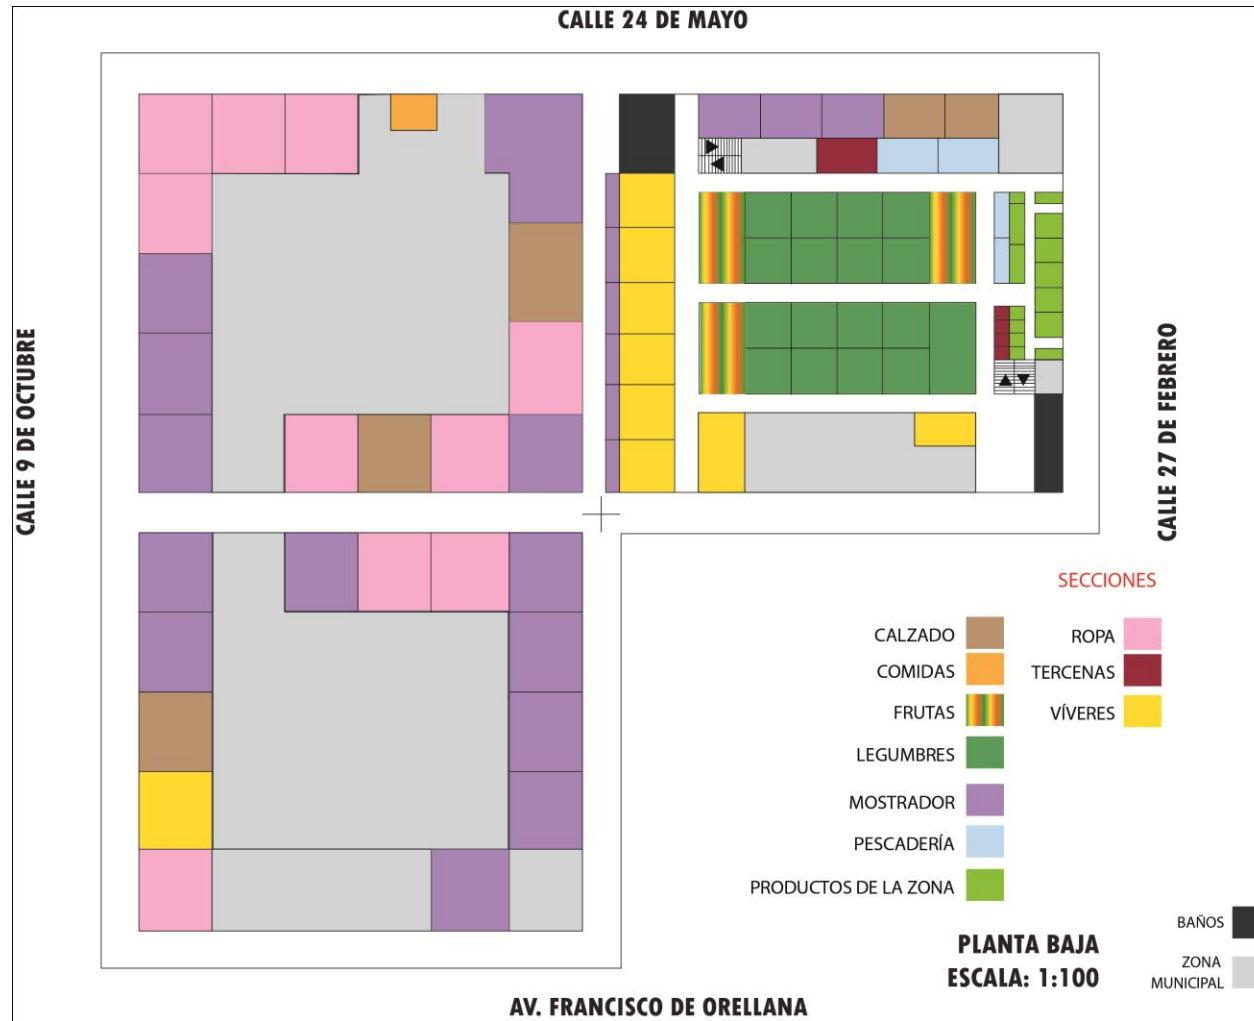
Secciones planta baja Mercado Central La Merced
